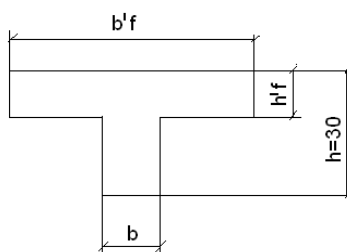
Схема определения площади сечения продольной растянутой и поперечной арматуры в продольных ребрах
